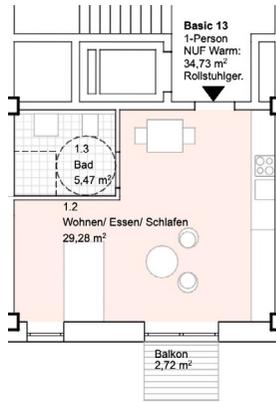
Grundriss Einzimmerwohnung | SoerenHoeller Architektur (Hamburg)
